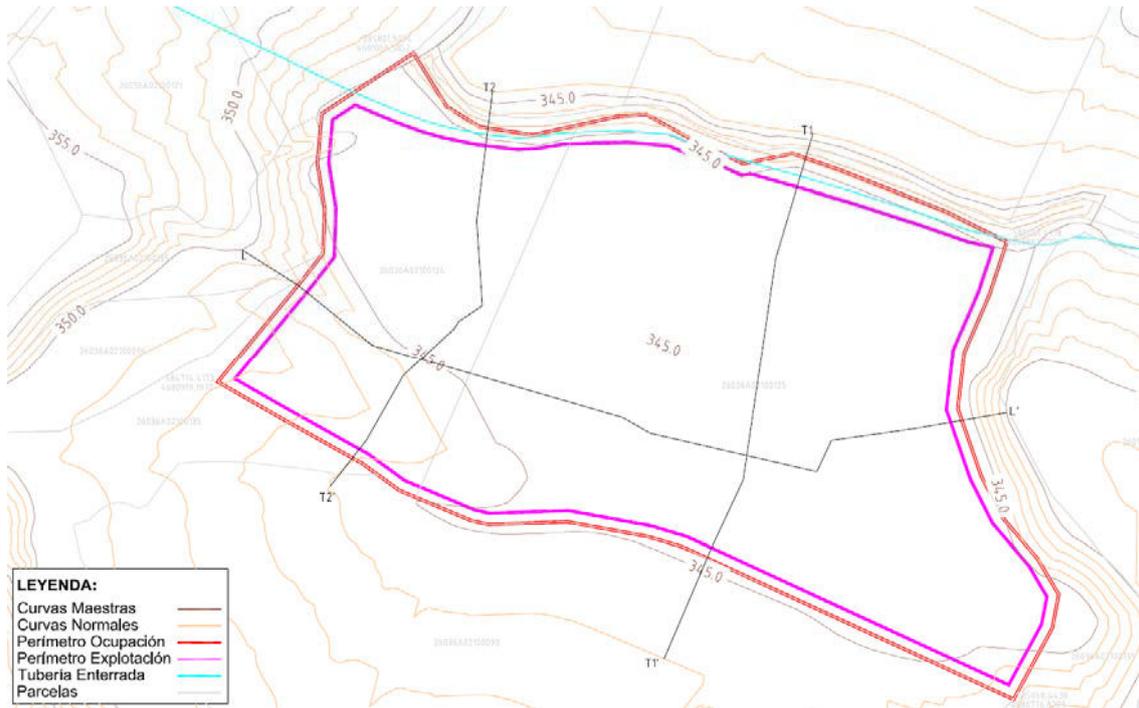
Extracto del plano 8. Topografía actual del plan de restauración.
